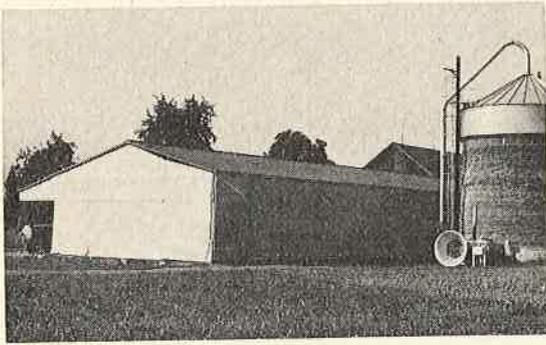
Stahlrohrhalle, mit Folien verkleidet
